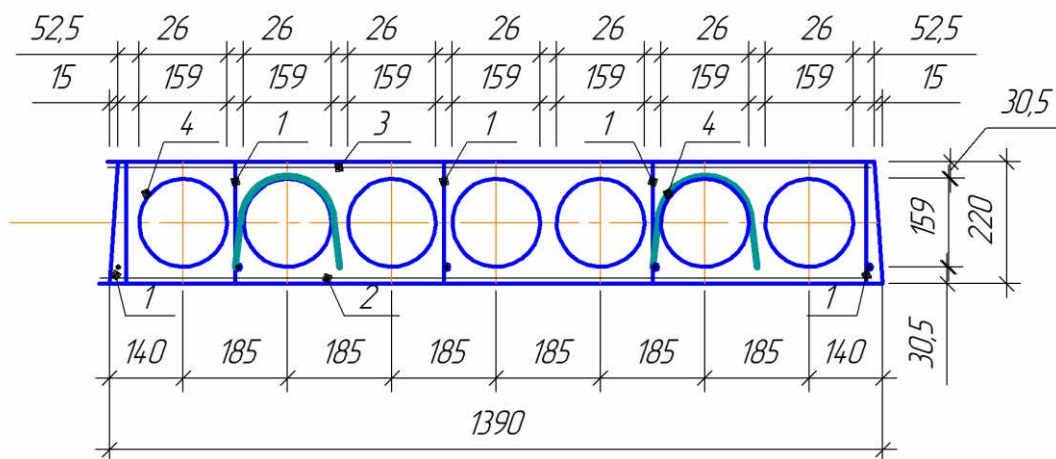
Поперечний переріз багатопустотної плити перекриття
